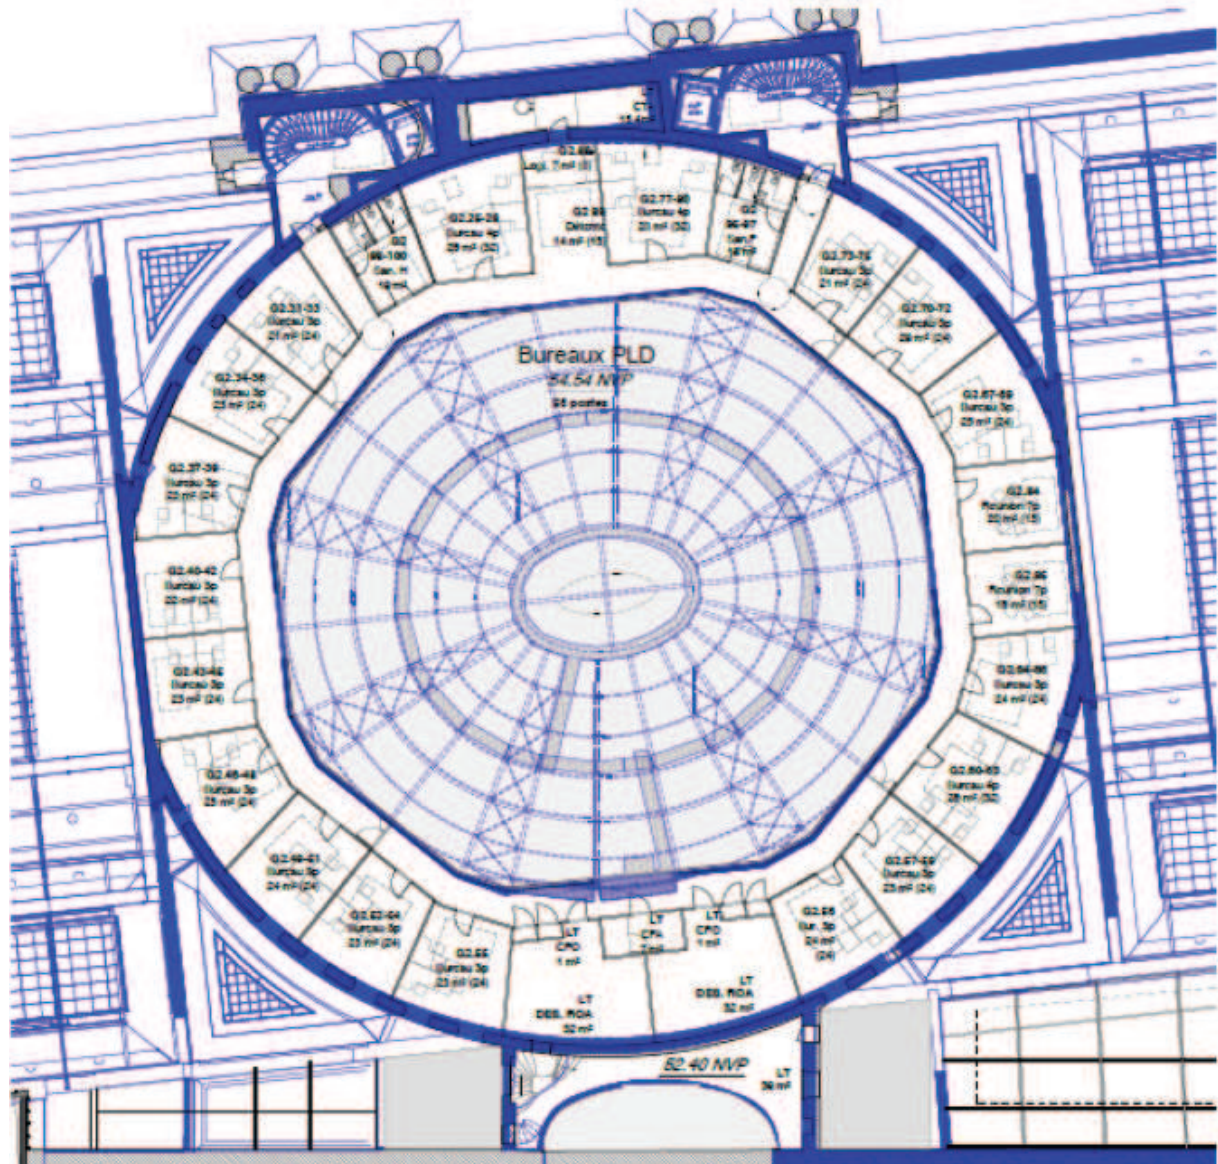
Combles du Palais d'Antin, plan des 56 postes de travail du Palais de la découverte (c) LAN
